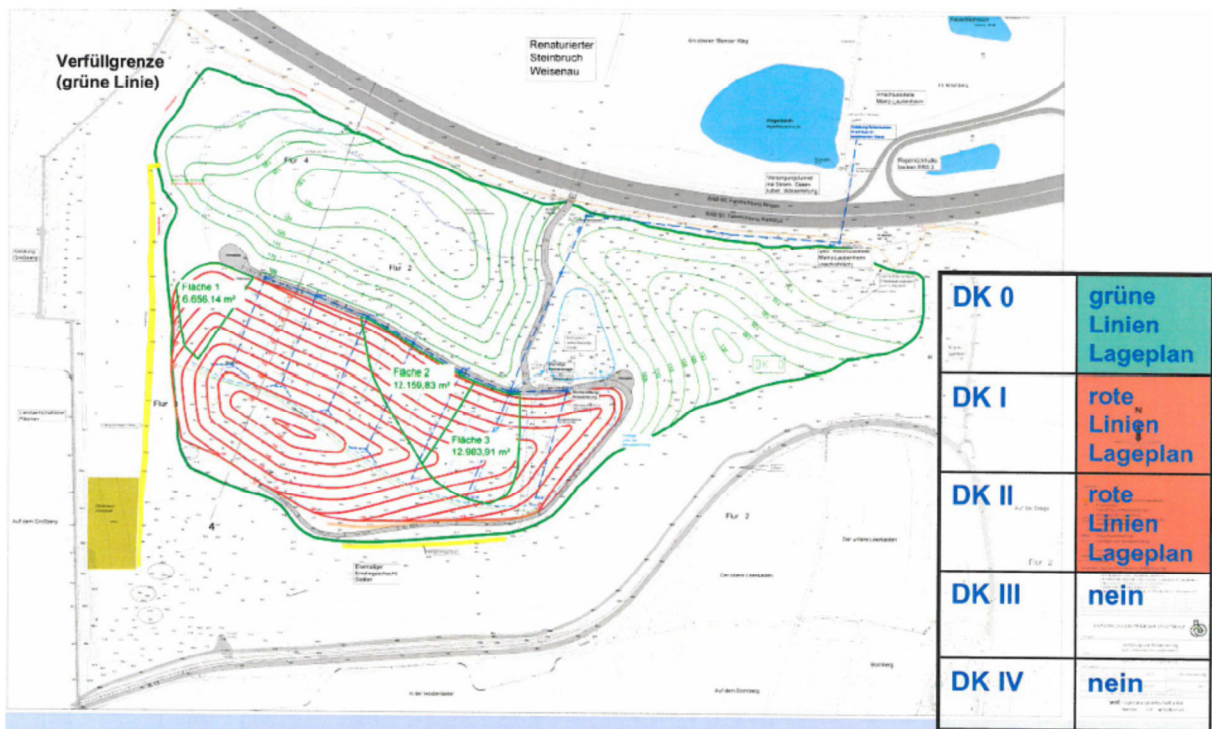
Lageplan mit Darstellung der geplanten Verfüllung am Steinbruch Laubenheim
